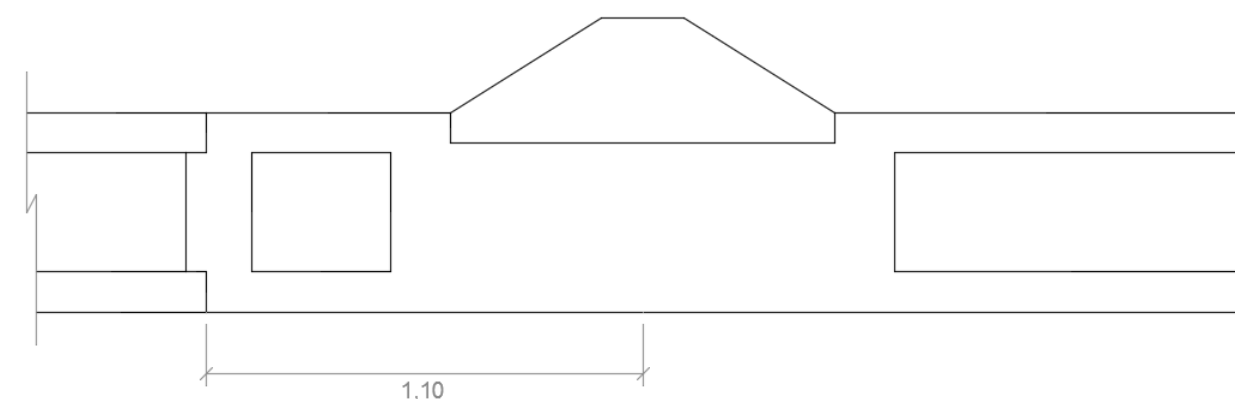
Detalle de unión viga longitudinal - viga longitudinal
